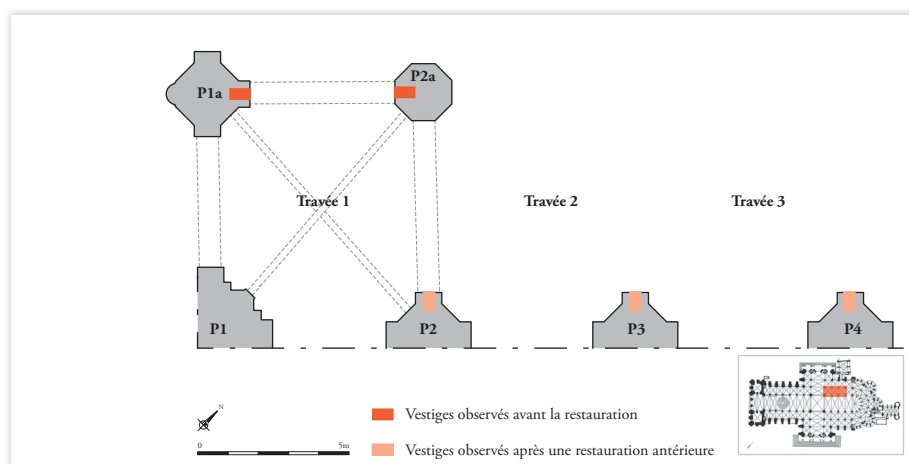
Localisation en plan des pièces de bois retrouvées dans la zone échafaudée pour le chantier – échelle : 1/250.
